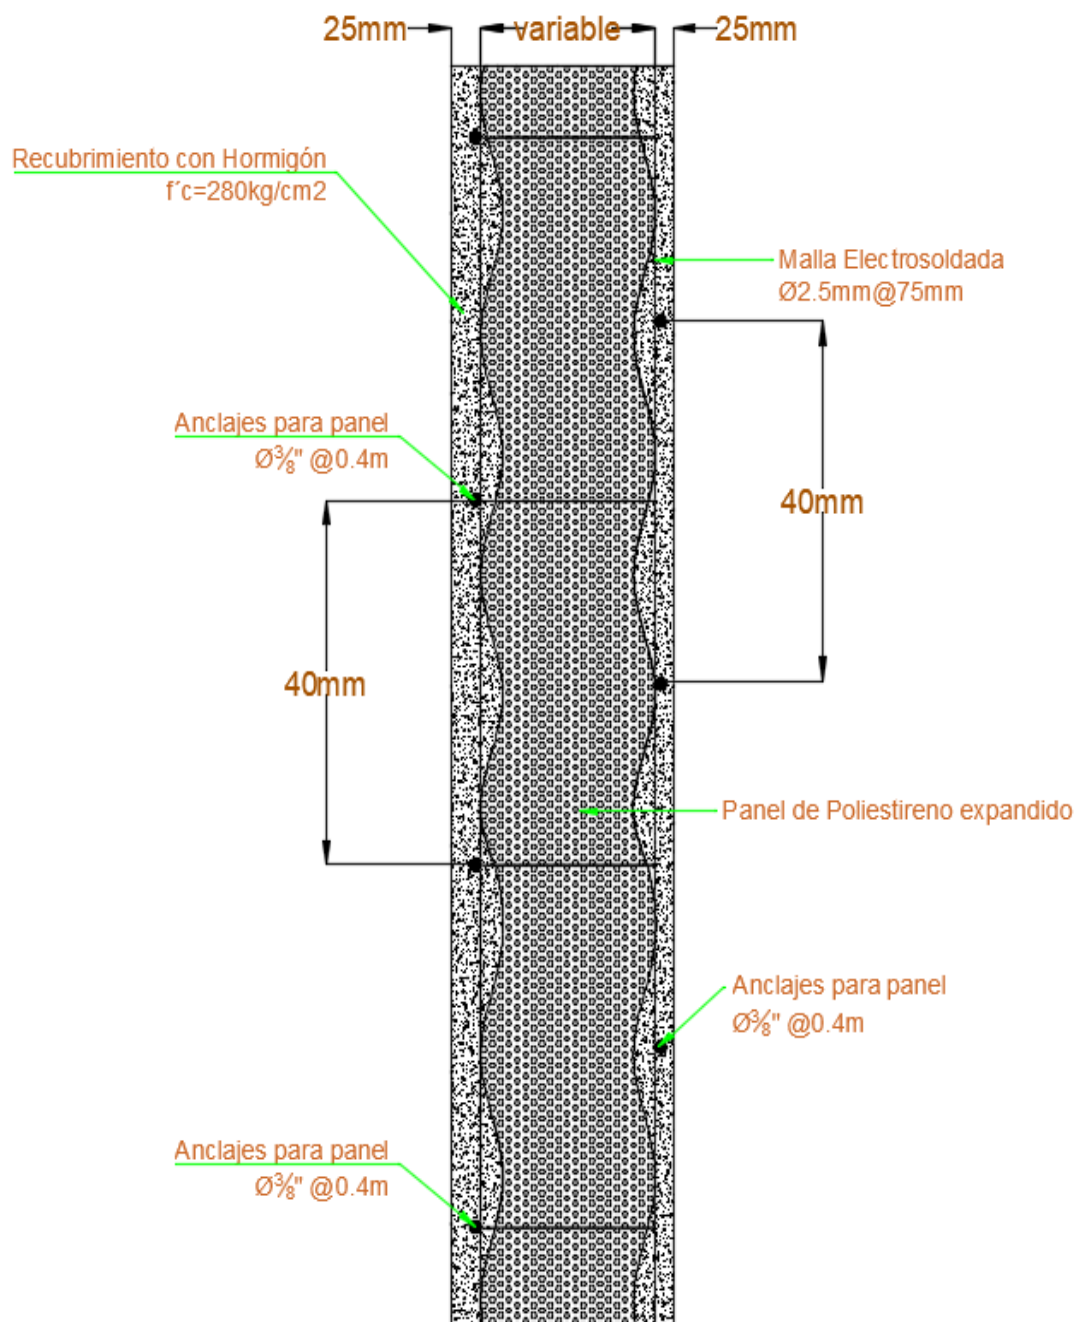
Detalle unión panel a cimentación (PLANTA)
